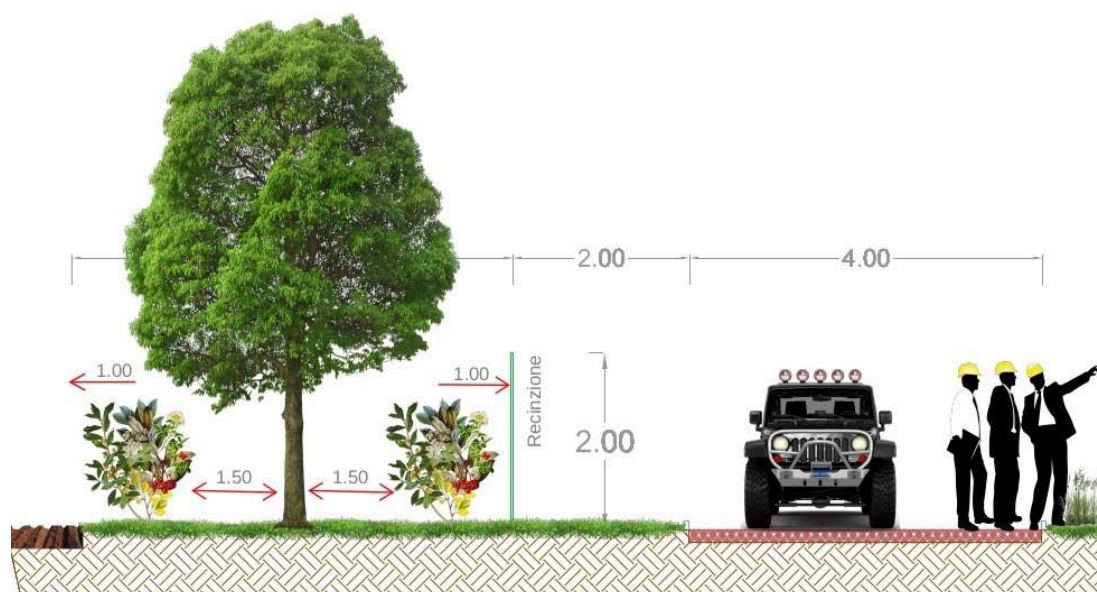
Schema prospettico di piantumazione della fascia tampone
